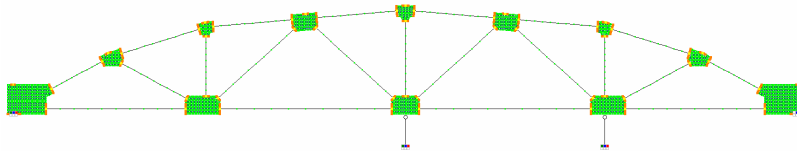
Варіант спирання двох стаяків на вузли нижнього поясу ферми
